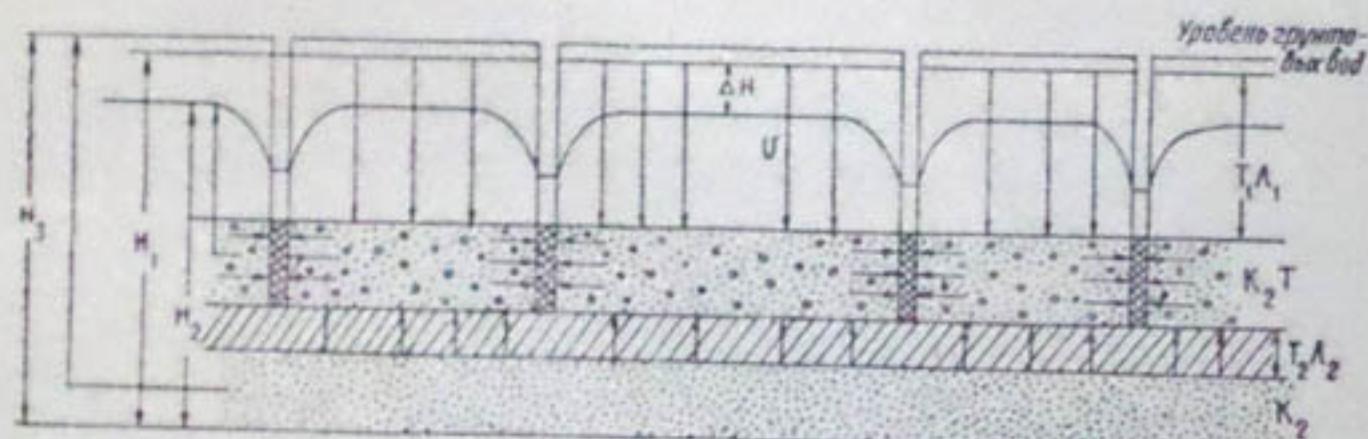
Схема расчета опытно-производственной системы вертикального дренажа (на участке бассейна):
